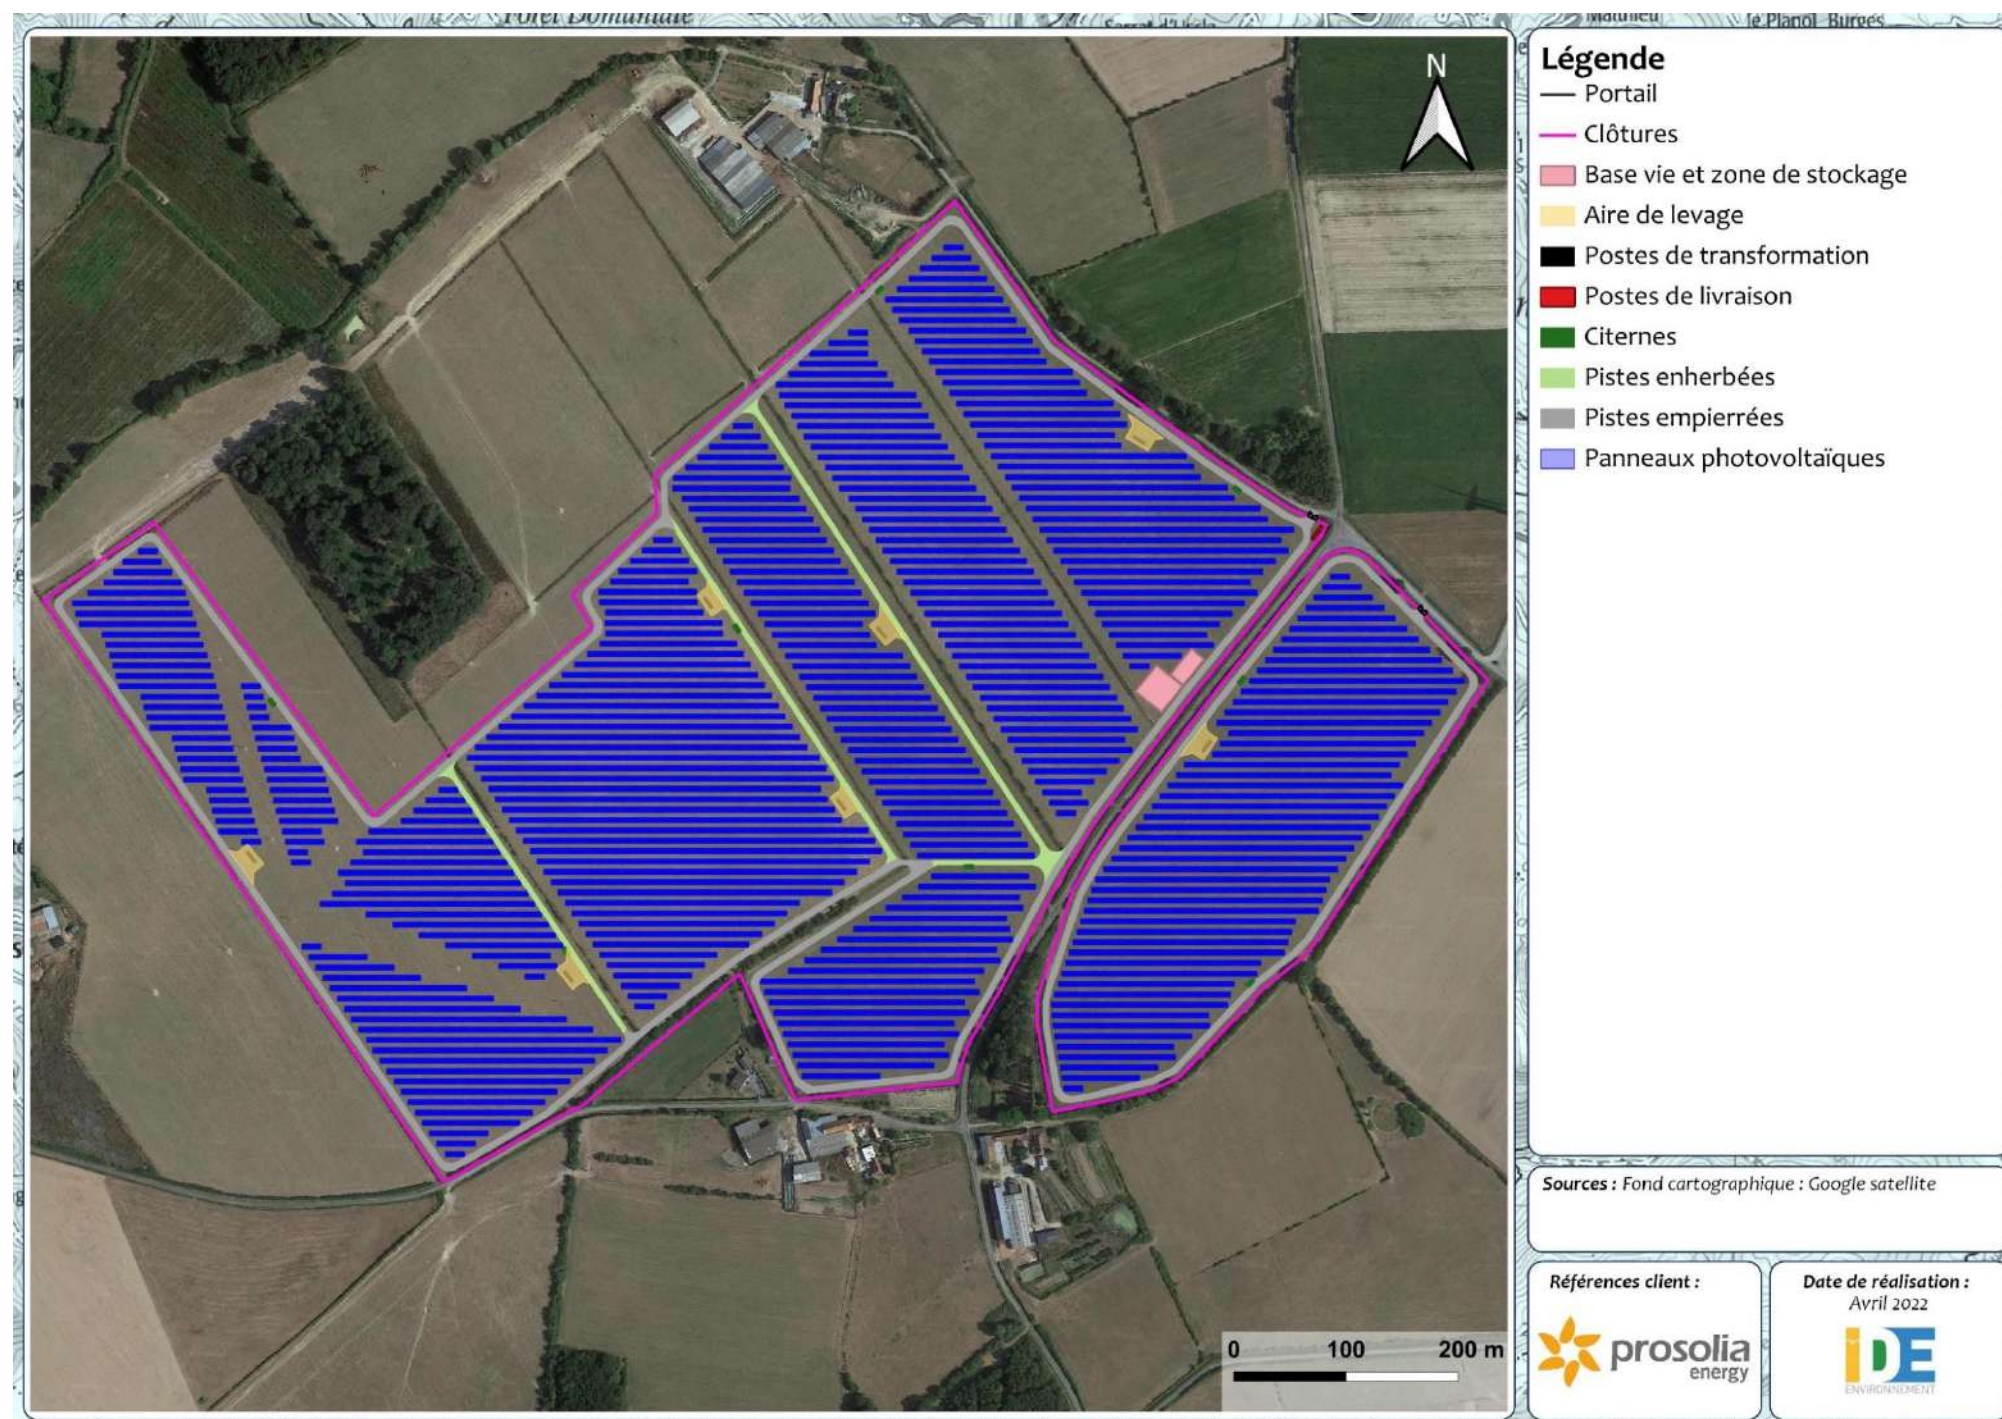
Plan d'implantation de la variante finale – Source : PROSOLIA Energy
